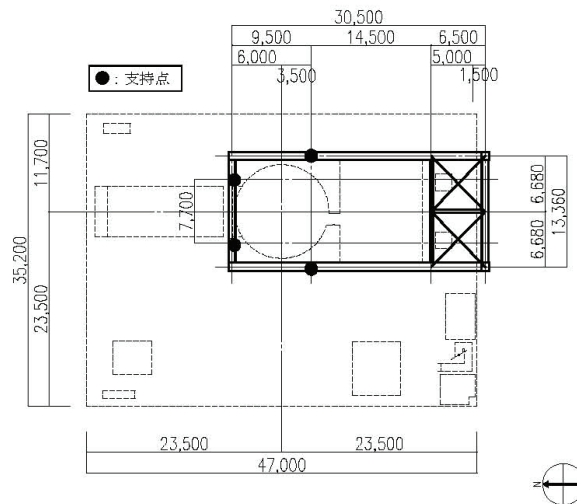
燃料取扱機支持用架構 梁伏図 (O.P. 41, 420)
